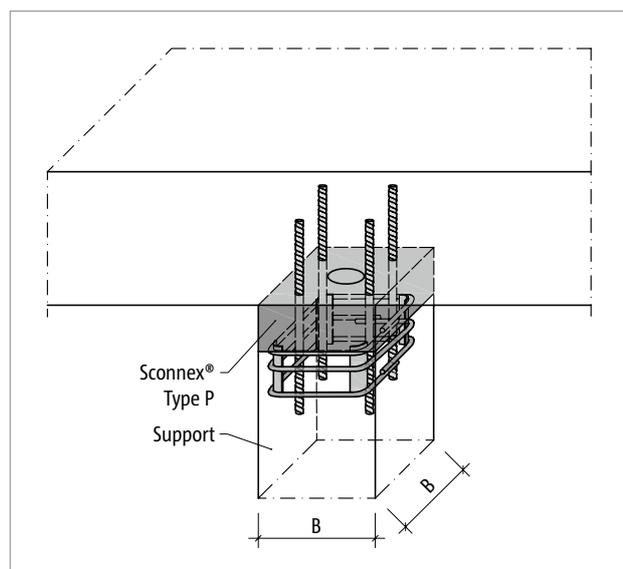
Schöck Sconnex® type P : raccordement pour un poteau carré
